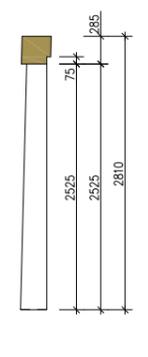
DETAIL LUEFTUNGSOEFFNUNG DETAIL VENTILATION OPENING
